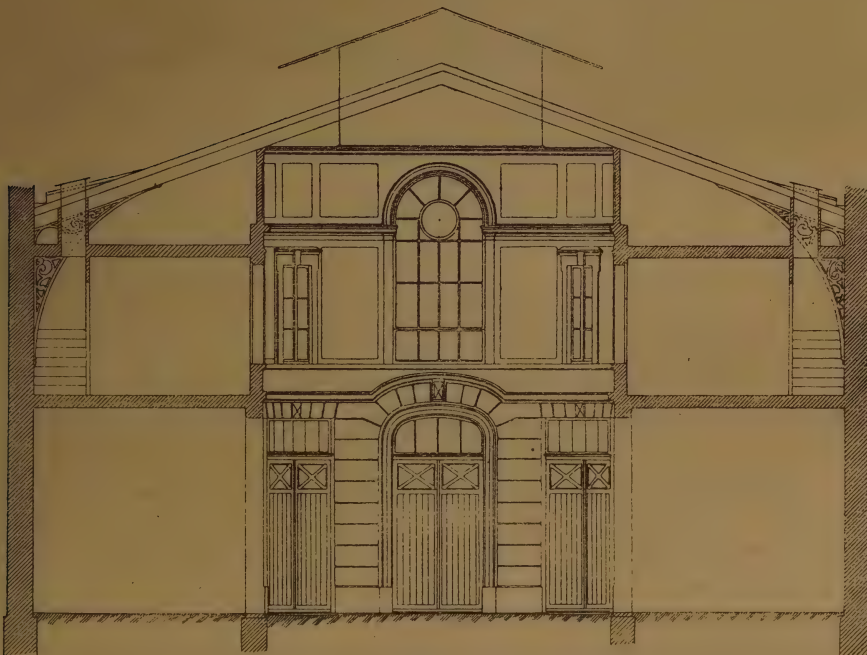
Communs, avenue Kléber à Paris. Coupe transversale sur le hall de service.
